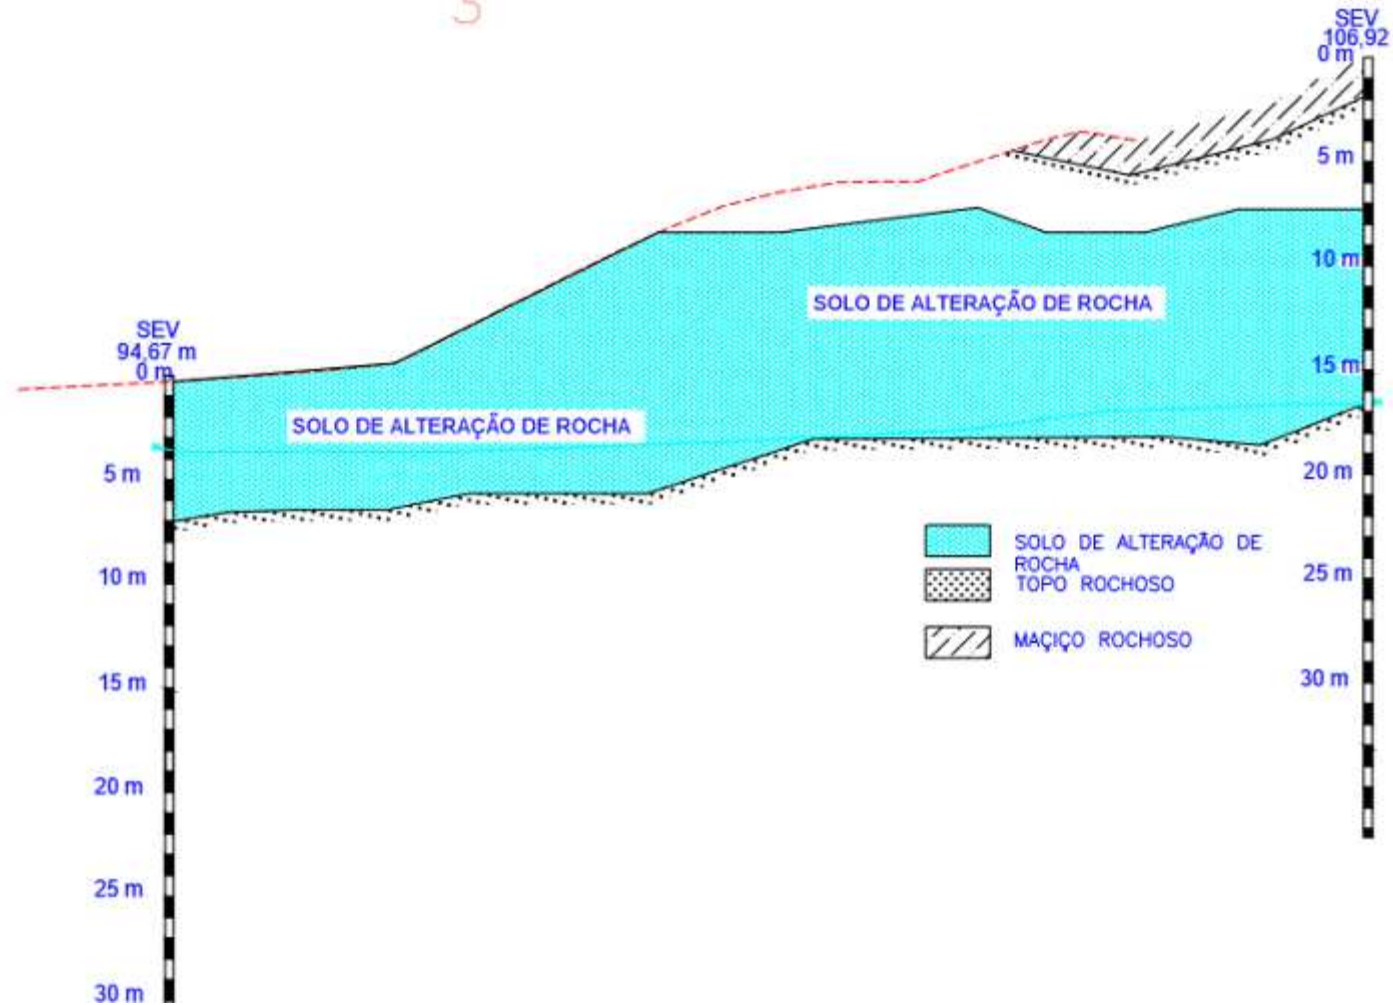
Perfil Geotécnico definido pelas Sondagens Mistas – Seção “FF”.
